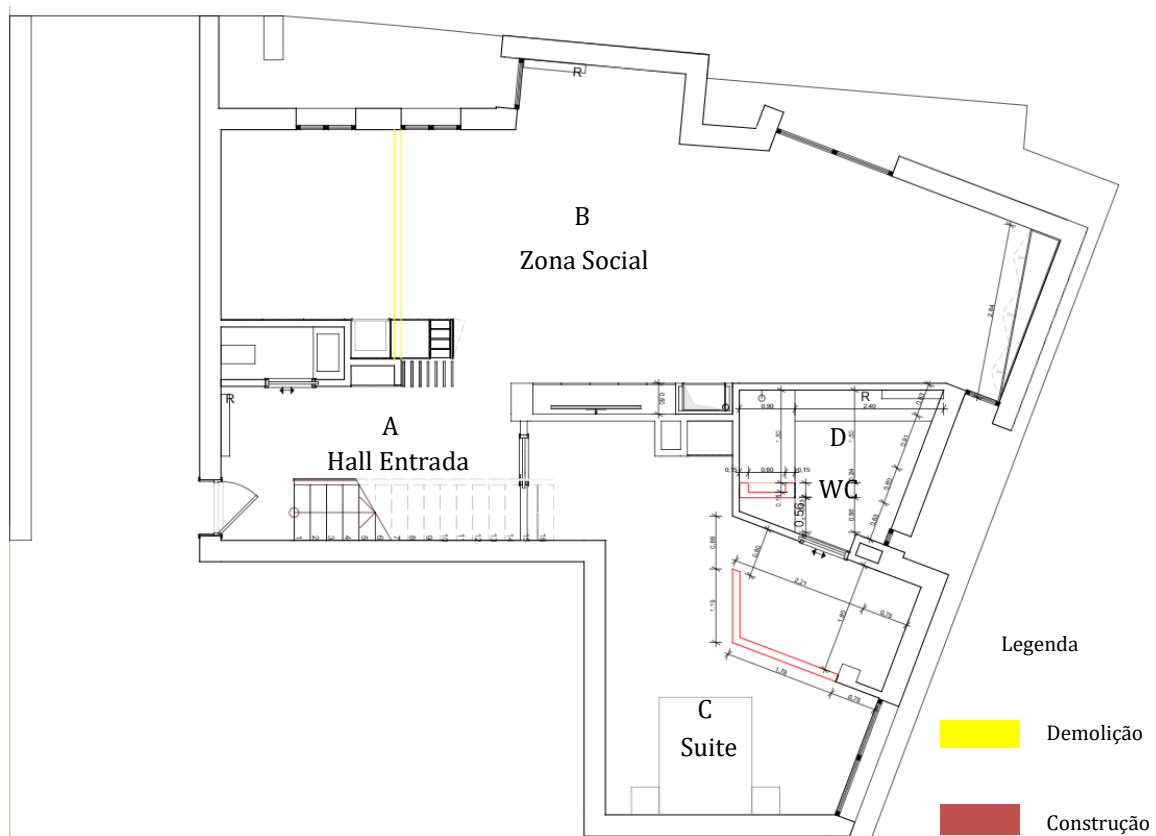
Planta de Alterações | Piso 0. Fonte: 2L'atelier
